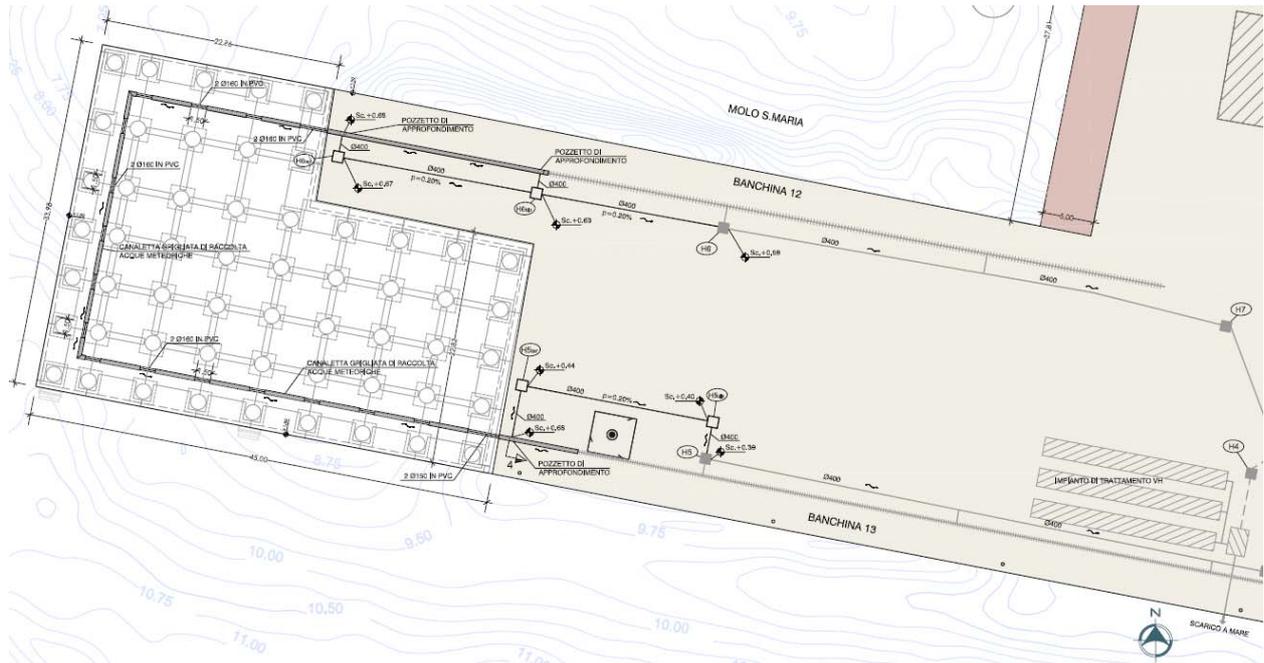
Planimetria Idraulica - impianto di raccolta acque meteoriche
